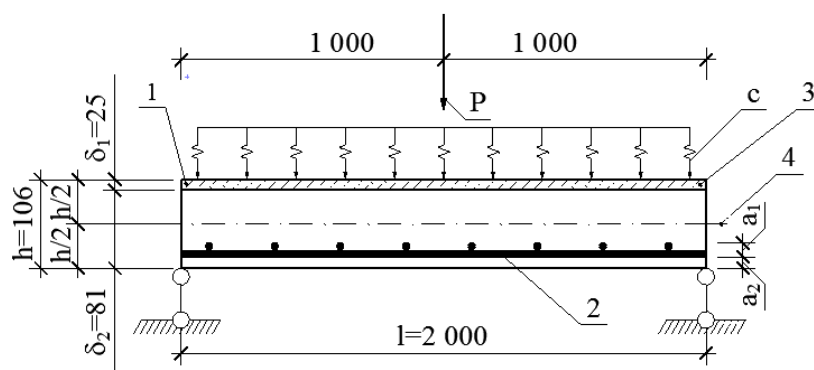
Показано сечение 3-3 для плиты № 3: где 1 – железобетонные слои; 2 – армированные слои; 3 – слой эпоксидного полимербетона; 4 – срединная поверхность; q – нагрузка в форме давления [16]
